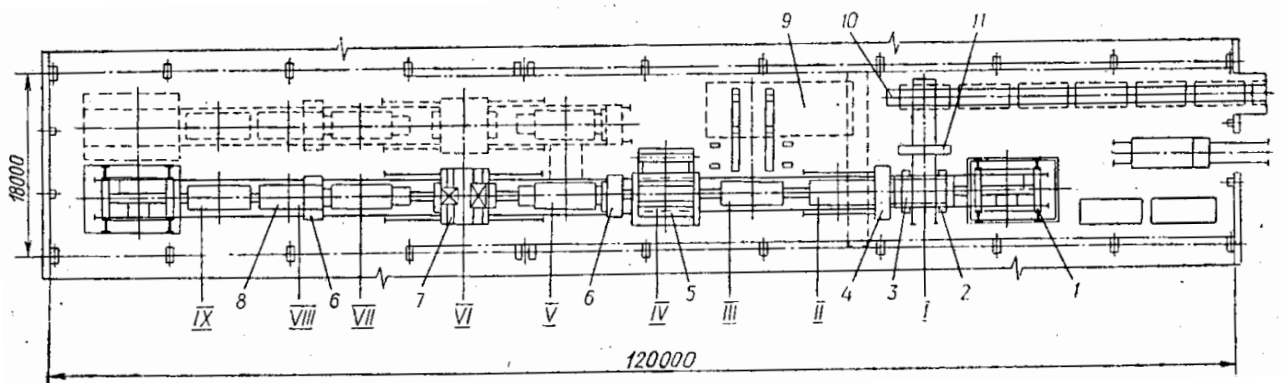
Конвеєрна лінія виготовлення багатопорожнинних плит:
